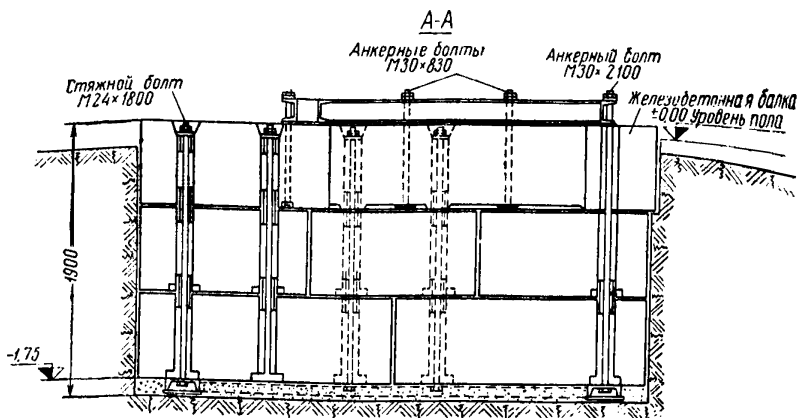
Фундамент под лебедку 2ЛП-5/500
